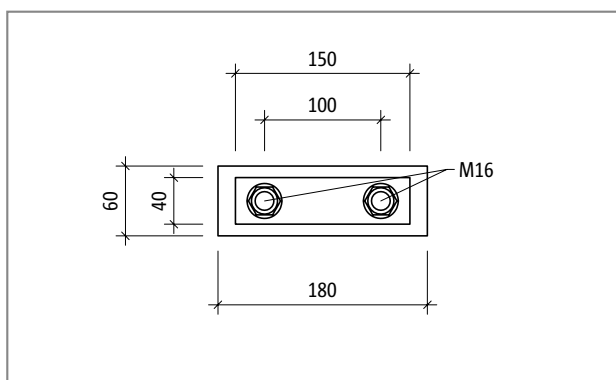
Schöck Isokorb® T tipo S-N-D16: vista dell'elemento
